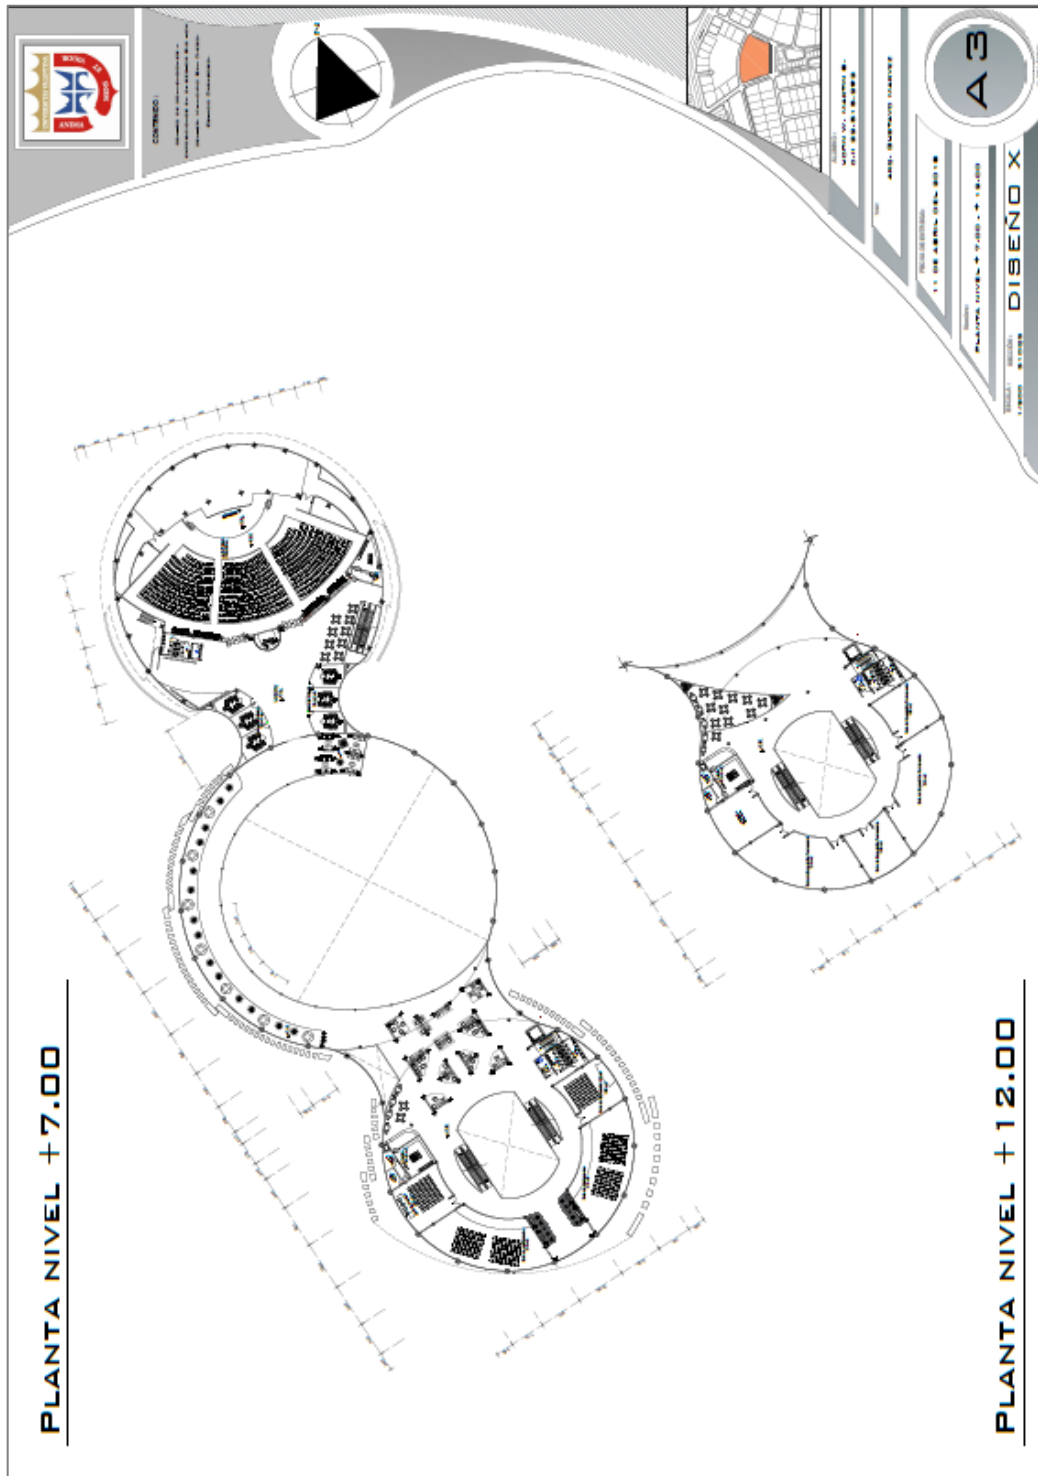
Plano nivel +7.00 y +12.00 (2018)
